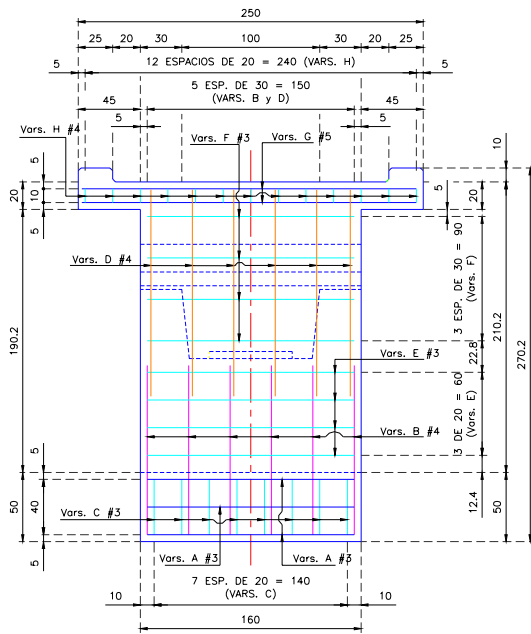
y 2.12 Estribo No. 1 Geometría.
